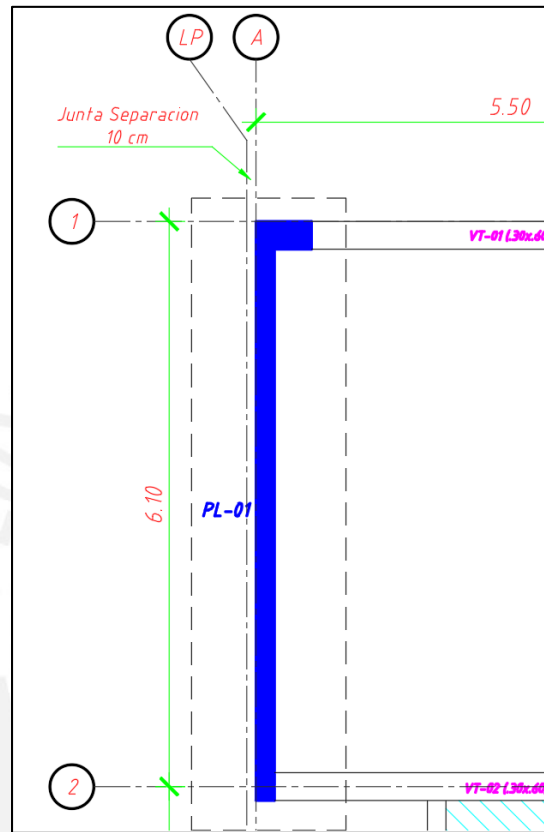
Placa PL-01 en el plano de encofrado. Primer piso.
